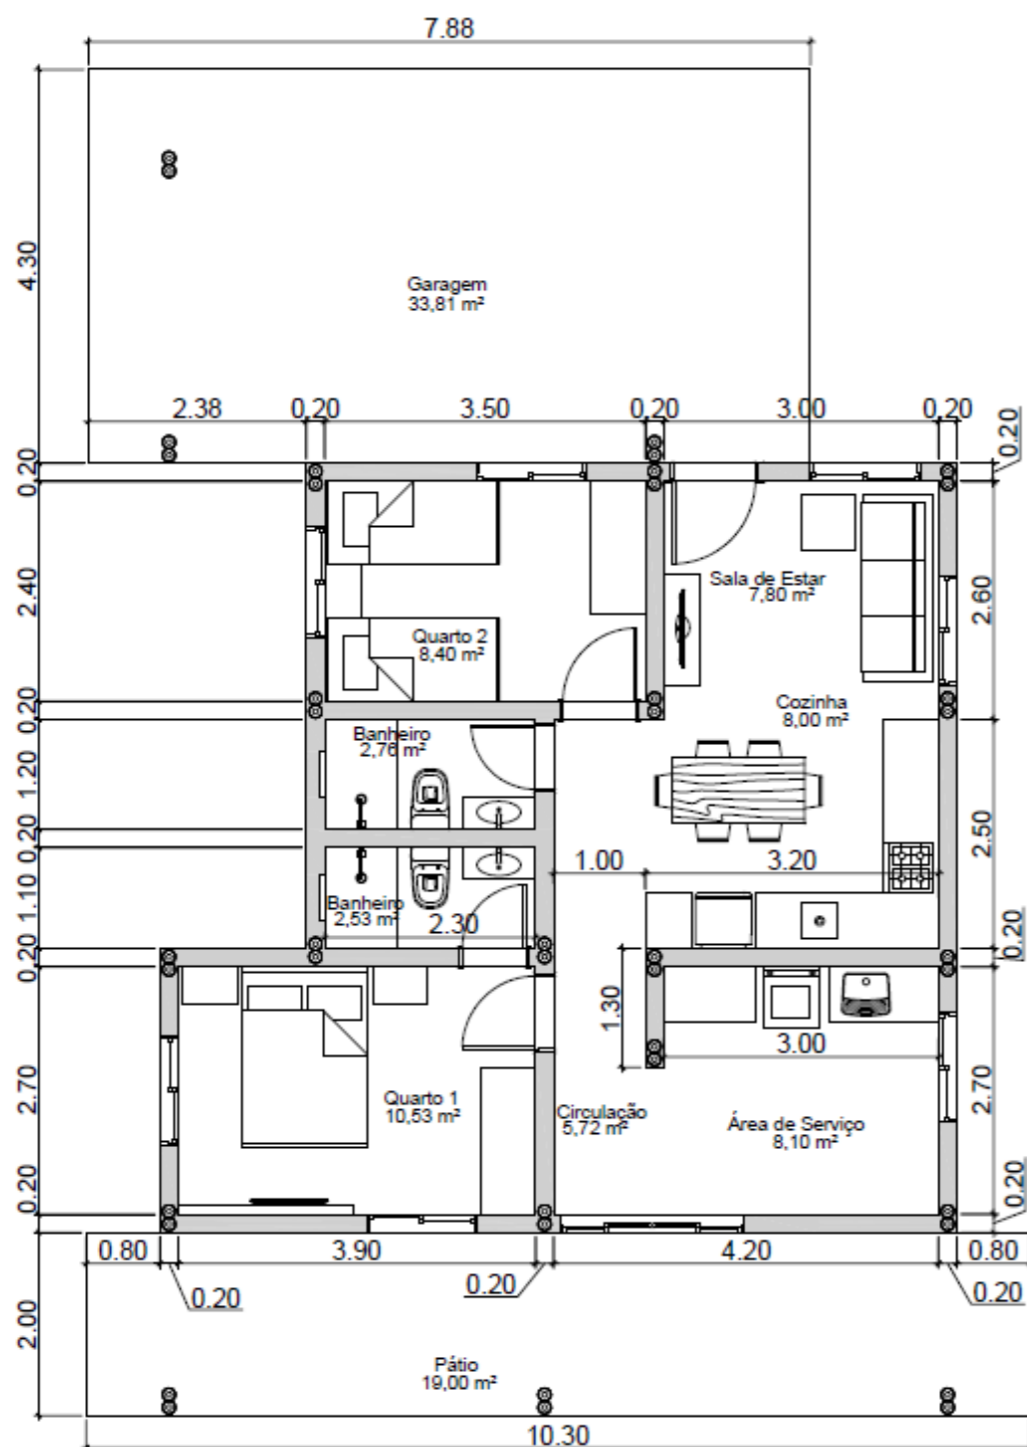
Planta da habitação proposta em bambu. Fonte: elaborado pelos autores.
